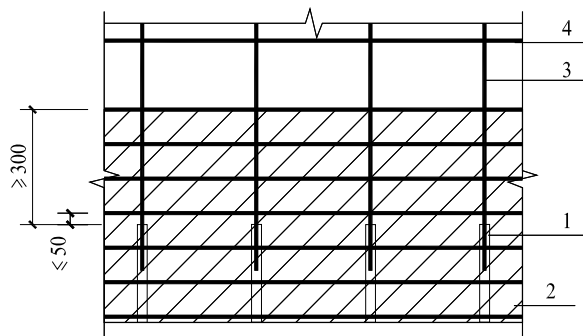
钢筋套筒灌浆连接部位水平分布钢筋的加密构造示意
